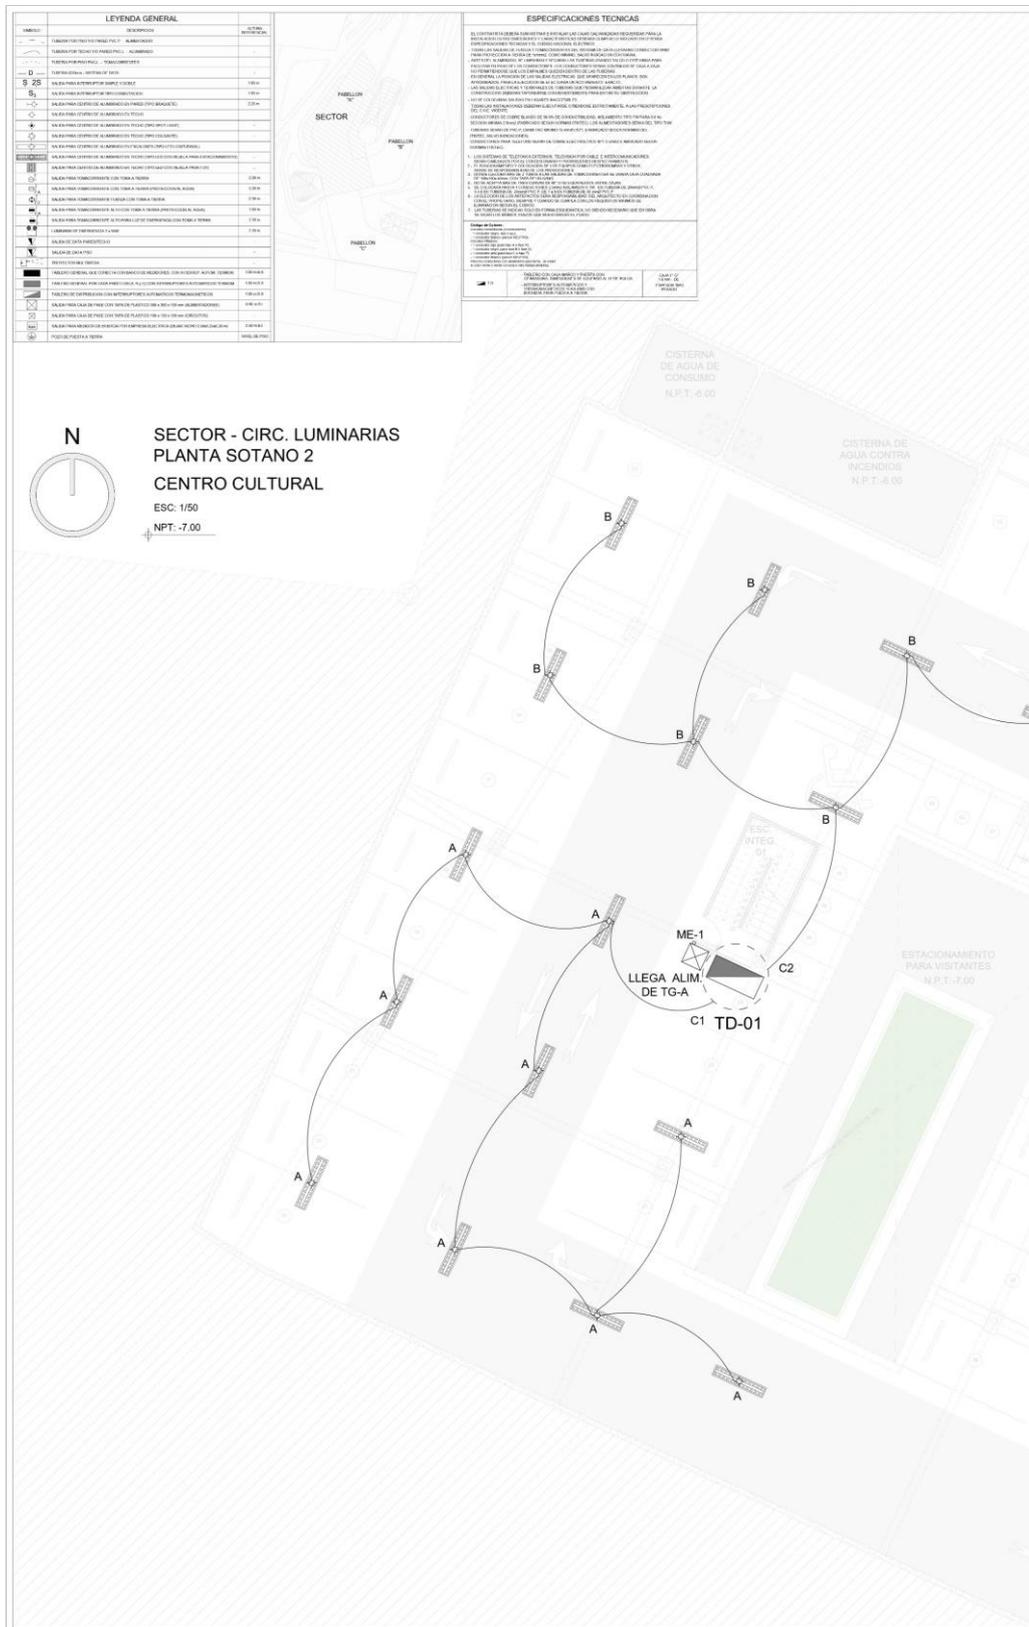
Planta especialidad eléctricas – Luminarias – Sótano 2
